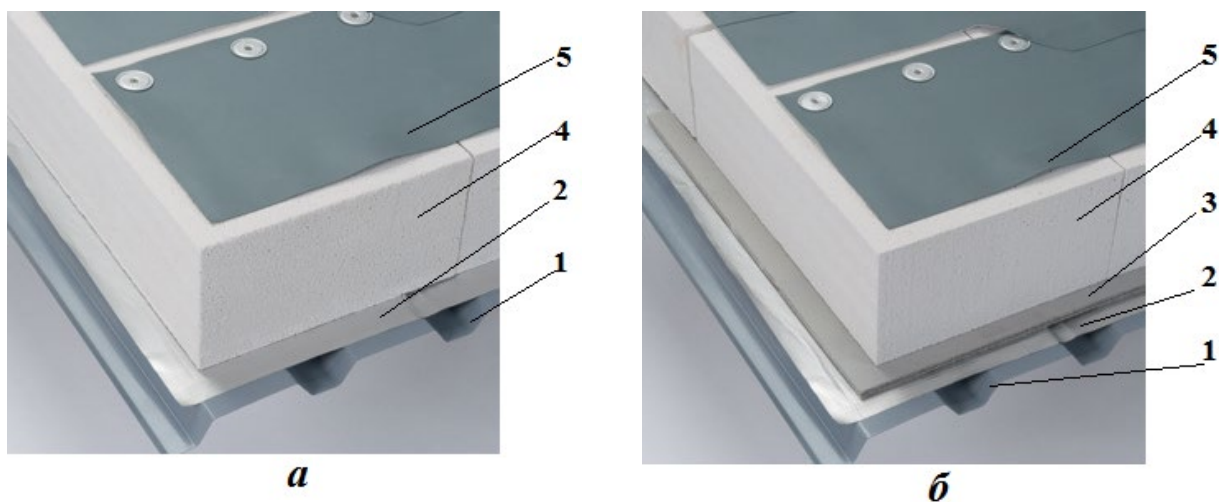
Система полимерной кровли с механическим креплением и плитами Multipor в качестве теплоизоляции: а — без опоры для теплоизоляционного материала; б — с опорой для теплоизоляционного материала; 1 — профилированный лист; 2 — пароизоляция (многослойная алюминиевая фольга); 3 — опора для изоляционного материала; 4 — минеральная изоляционная плита; 5 — полимерная мембрана, механическое крепление
